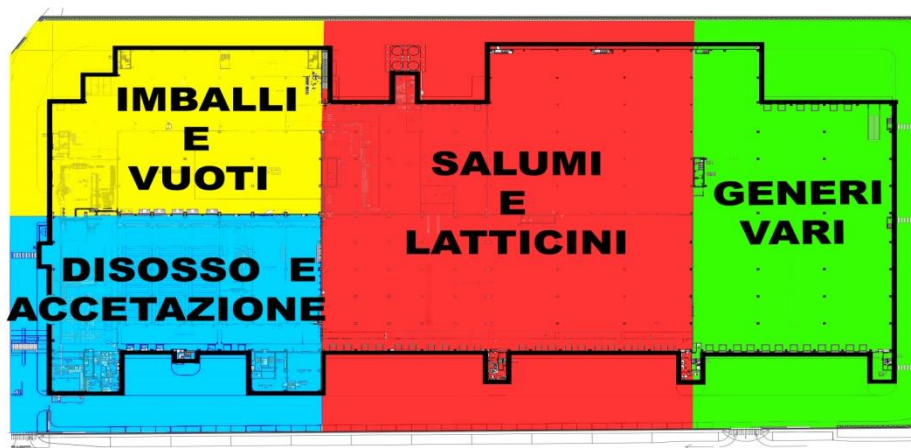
Planimetria della struttura aziendale, suddivisa in aree
